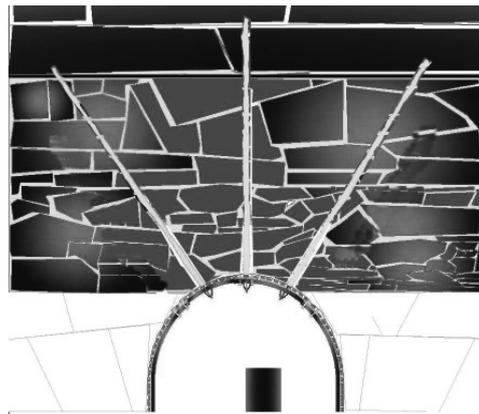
Схема усиления кровли штрека с помощью инъекционных анкеров
